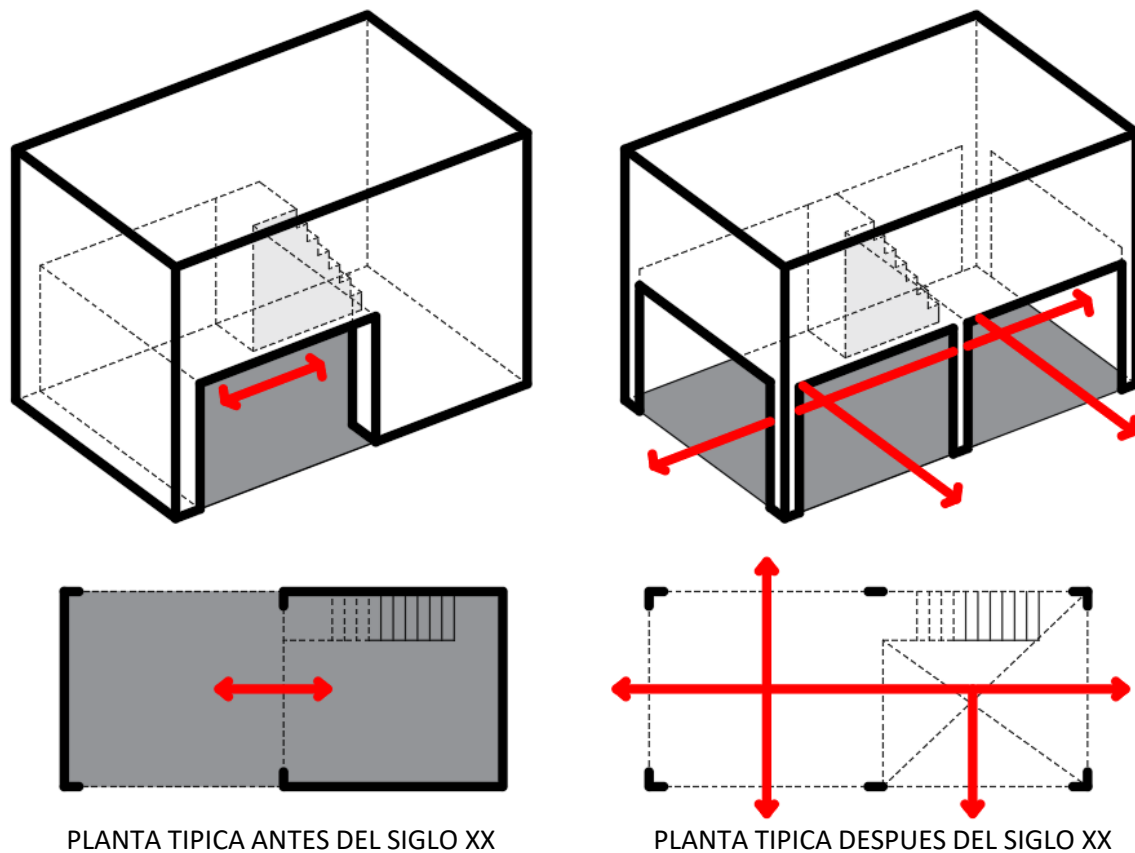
planta arquitectónica del siglo XXV – XX Fuente: elaboración propia
